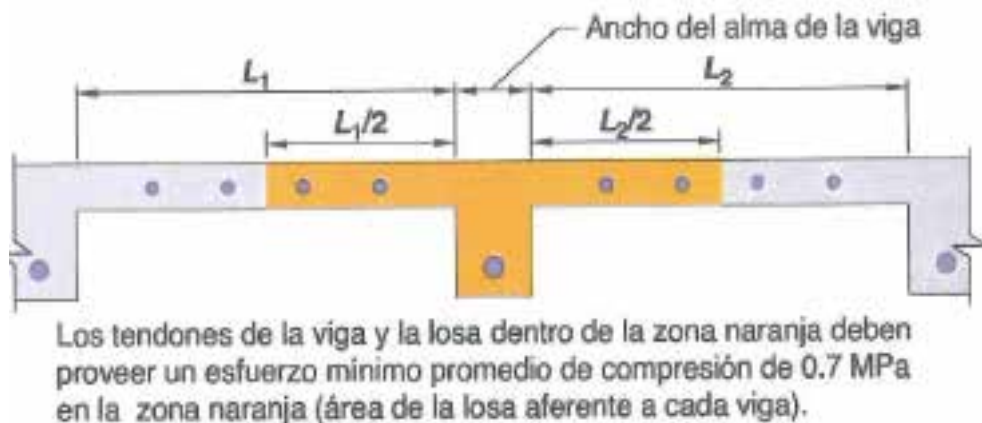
Secciones a través de vigas construidas monolíticamente losa Sec. AA
